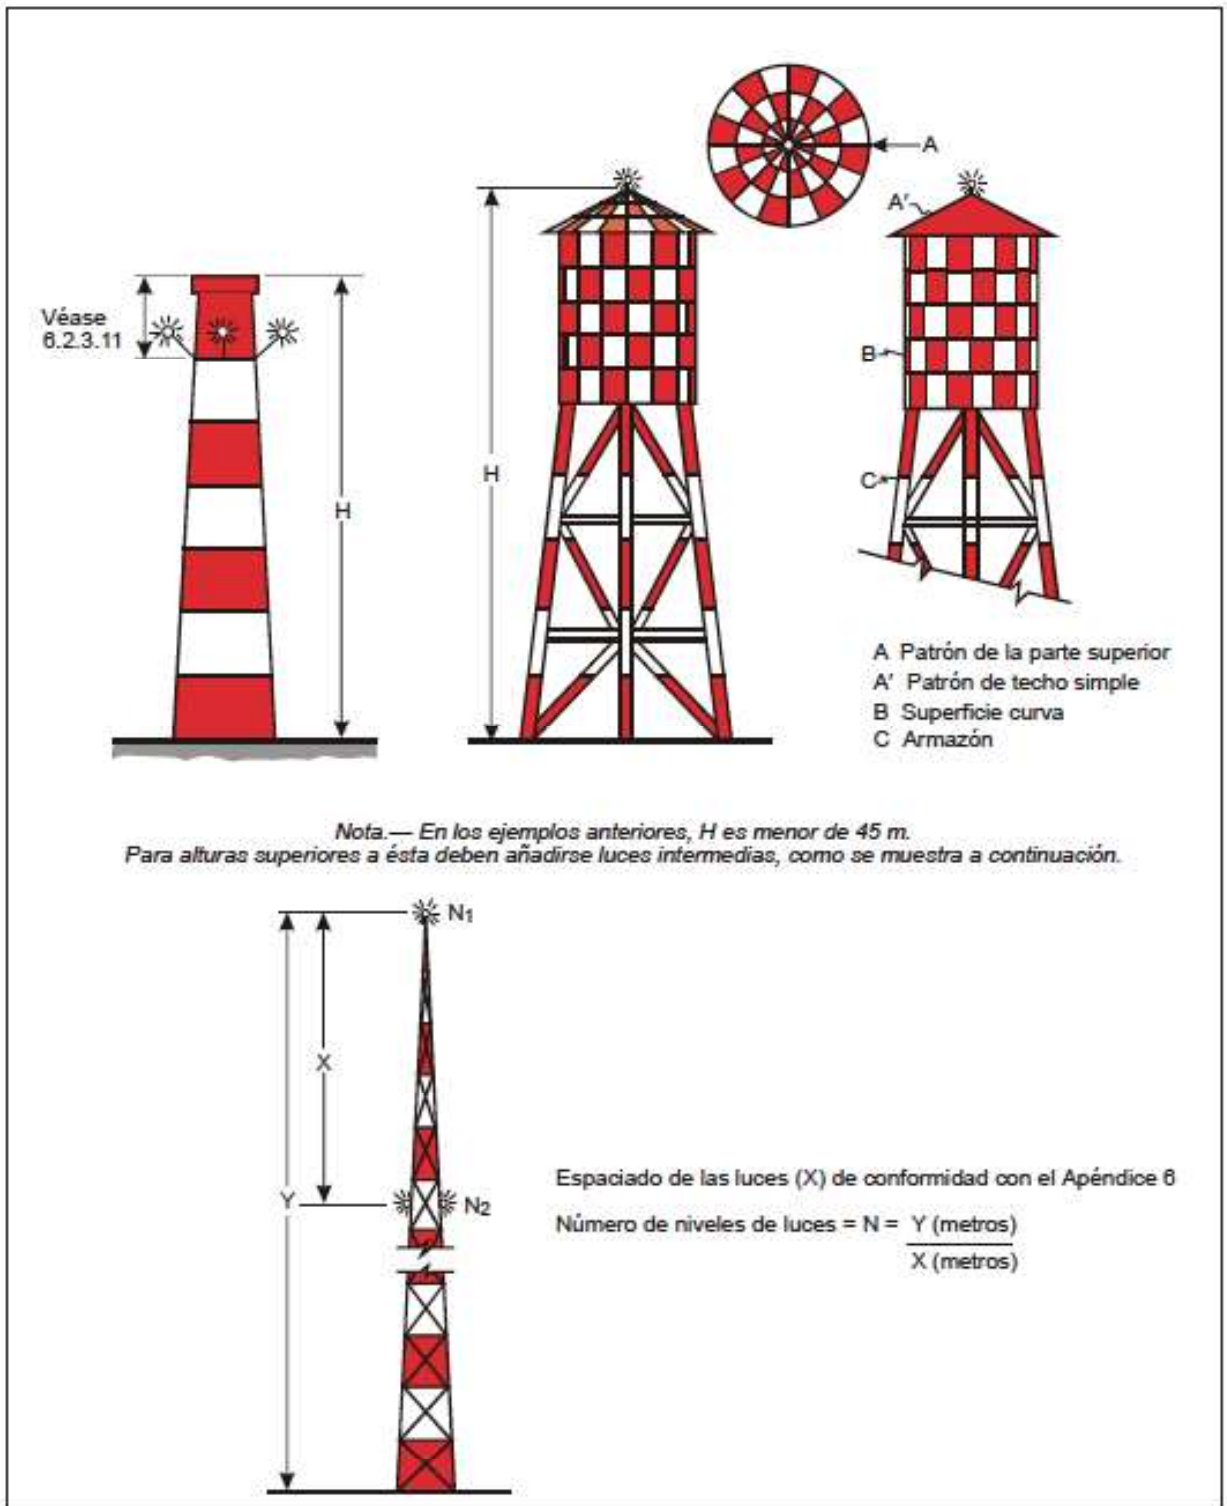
Ejemplos de señalamiento e iluminación de estructuras elevadas
